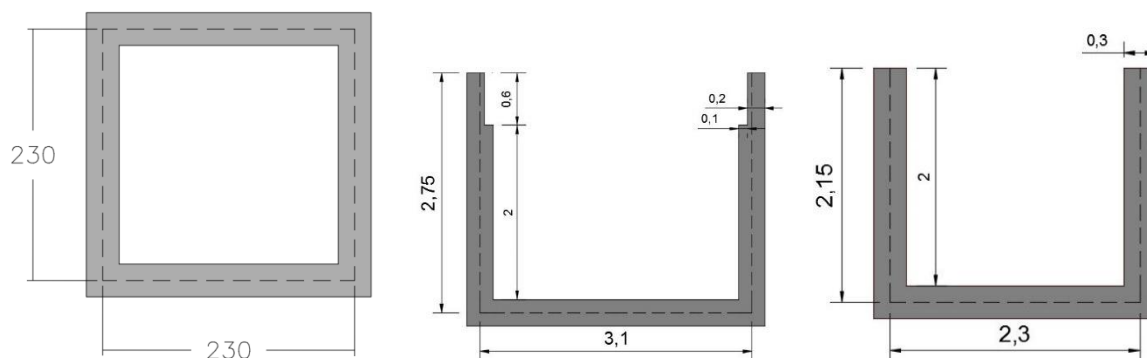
Modelli di calcolo SAP (tombino scatolare – muro S.d.S – muro canale)
